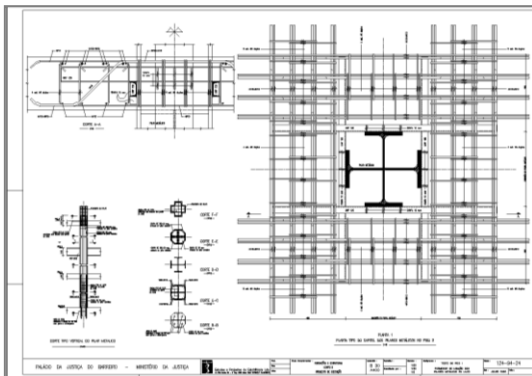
Pormenores de ligação dos pilares metálicos compostos às lajes
